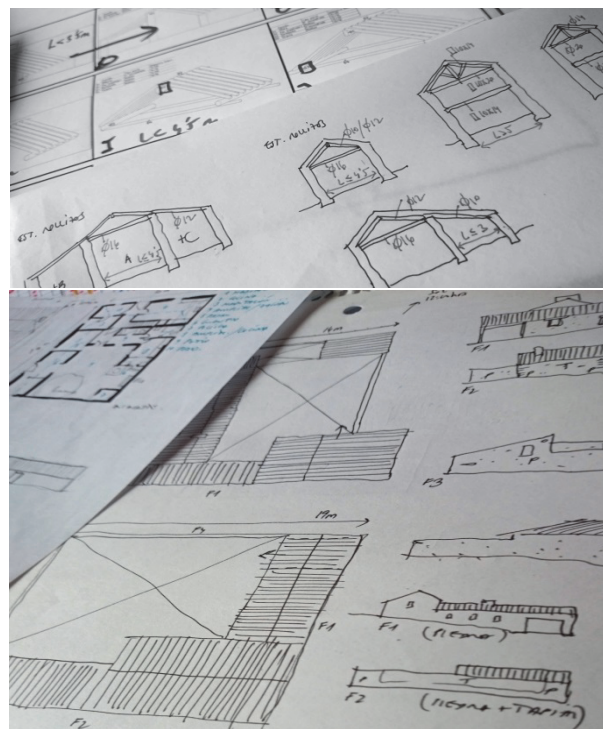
Imagen combinada de algunos de los croquis de alzados, plantas y secciones constructivas realizados durante el trabajo de campo. Fuente: la autora
